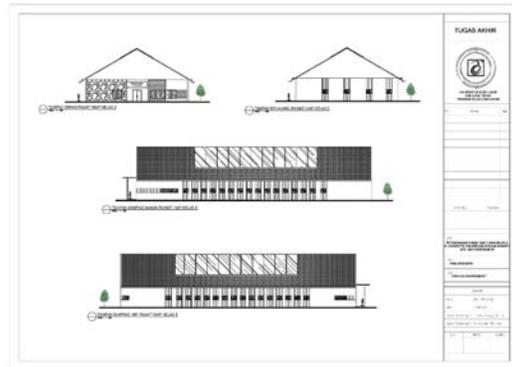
Tampak Depan dan Belakang Bangunan Rawat Jalan
